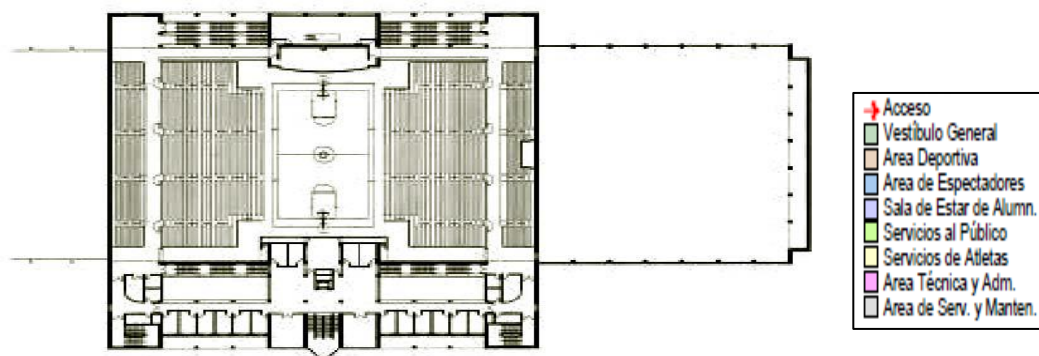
Segunda planta basketball arena and field house Ithaca, NY, eau
